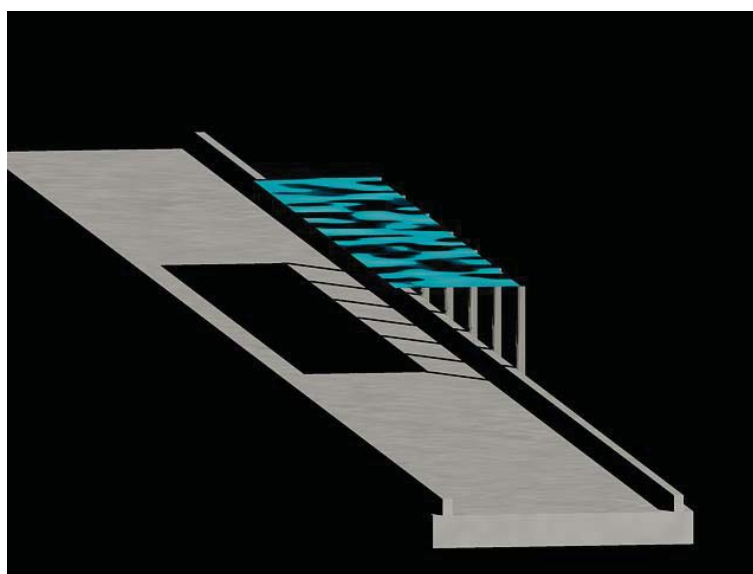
Estrutura metálica apenas de um dos lados da estrutura
